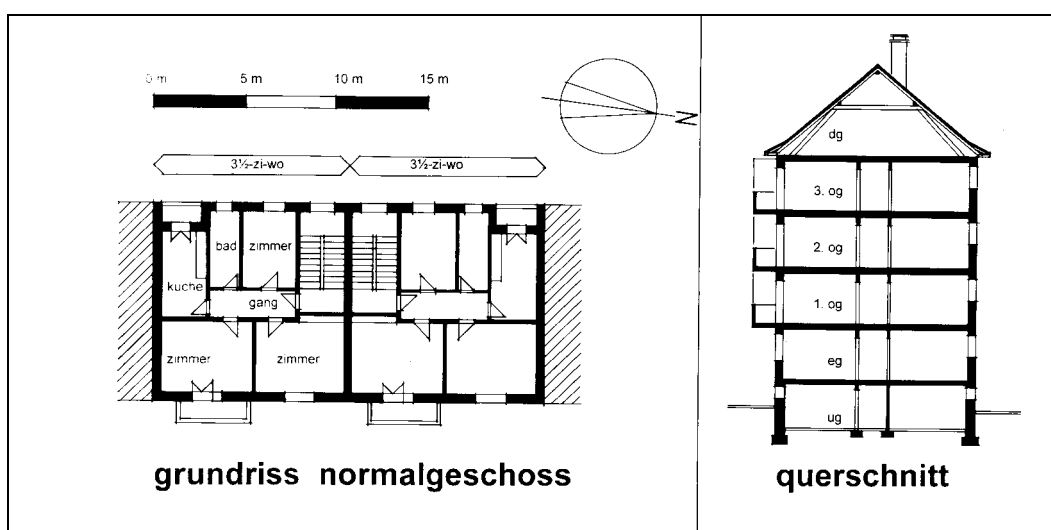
Grundriss Normalgeschoss und Querschnitt von Objekt 5.
